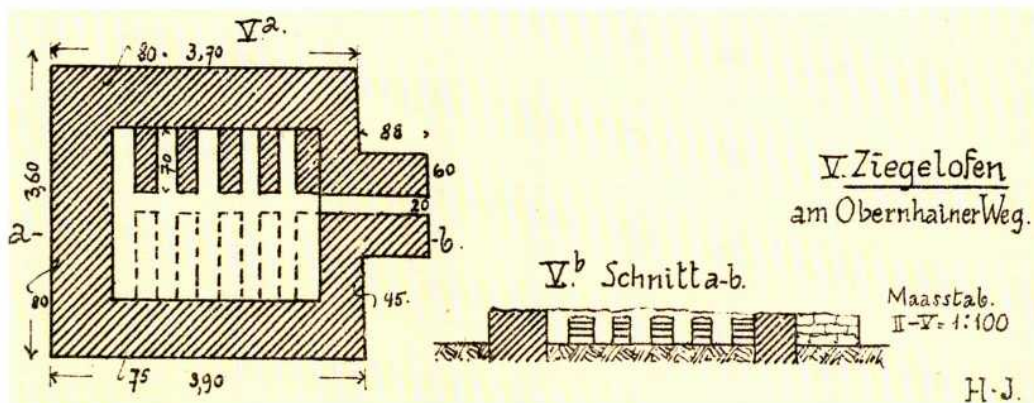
Grundriss und Schnittzeichnung durch die Feuerkammer. – Groundplan and section through the fire chamber.
